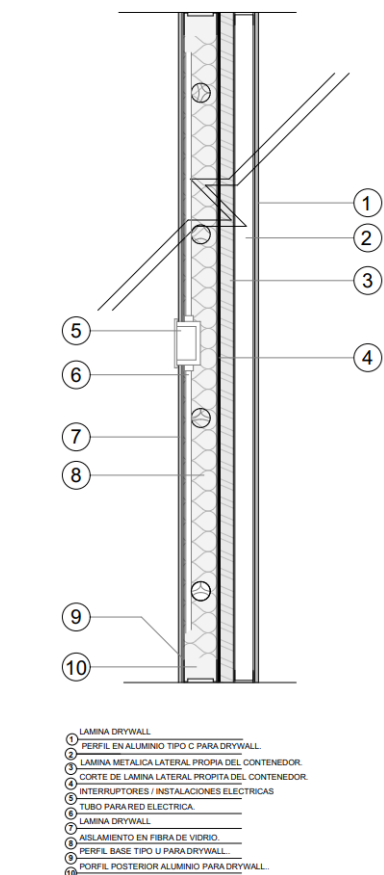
Detalle sección inferior del contenedorFigura 67. Muro con posibles instalaciones
